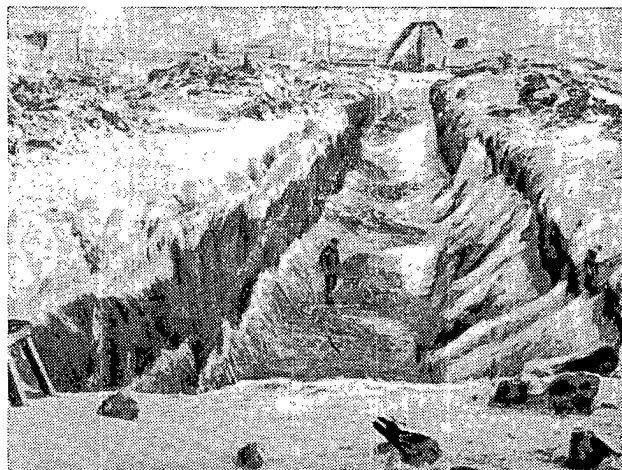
Общий вид отрытого бульдозером котлована (у одной стенки виден снежный нанос).
